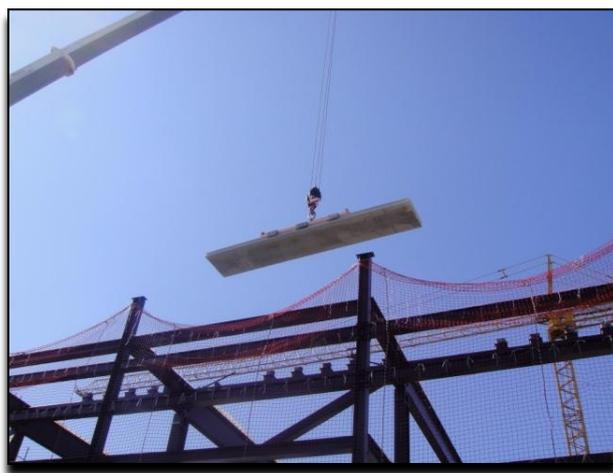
Colocação da laje alveolar em obra (Fonte própria, 2012)
